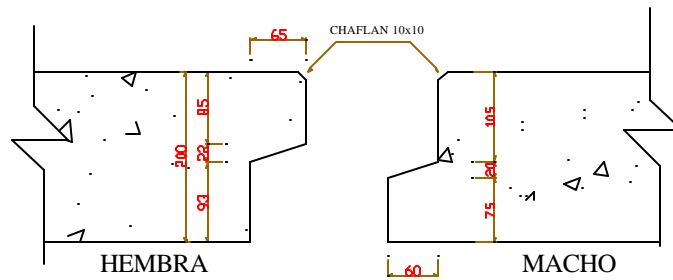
Detalle de unión Galería Prefabricada de Techo Plano
